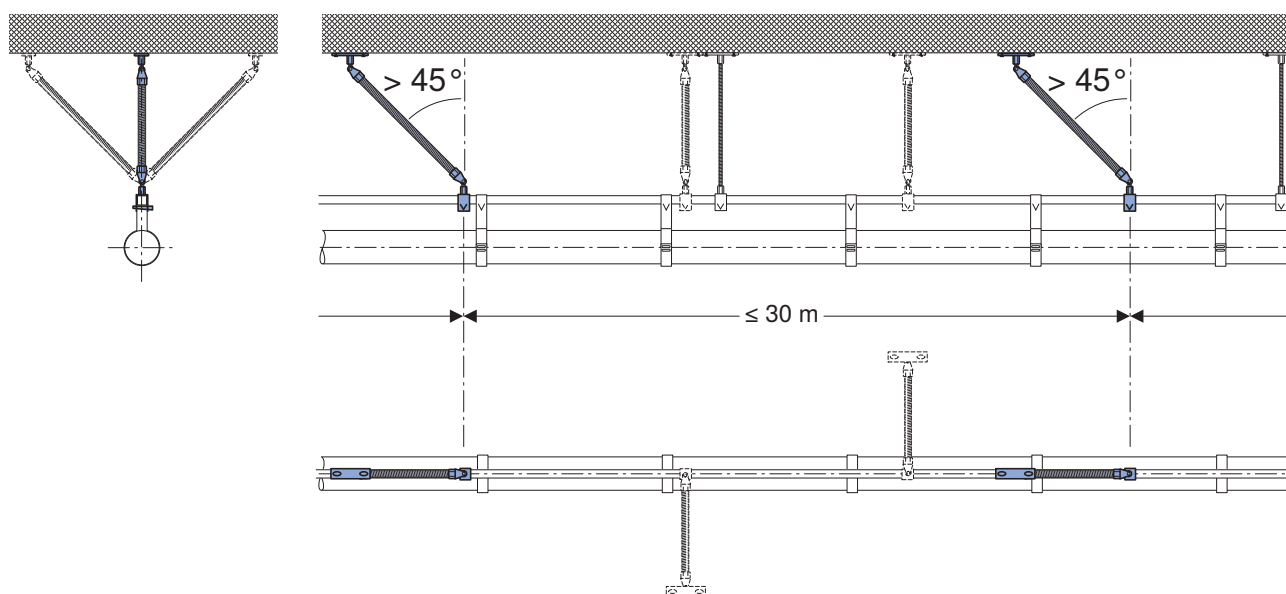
Disposition des kits de fixation de renfort Geberit Pluvia le long de la tuyauterie sur le plafond
